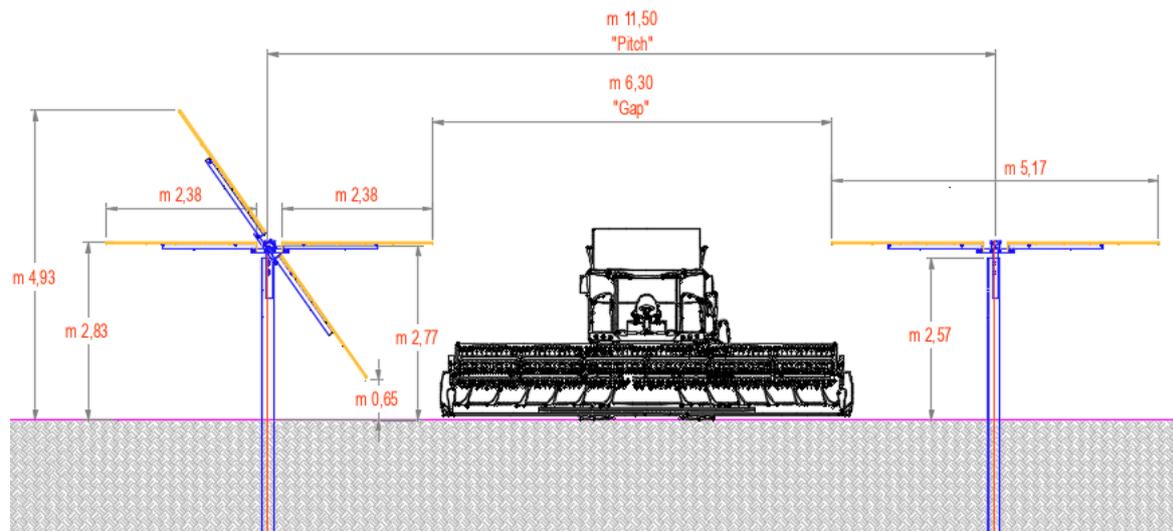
Vista delle strutture fotovoltaiche in sezione.
